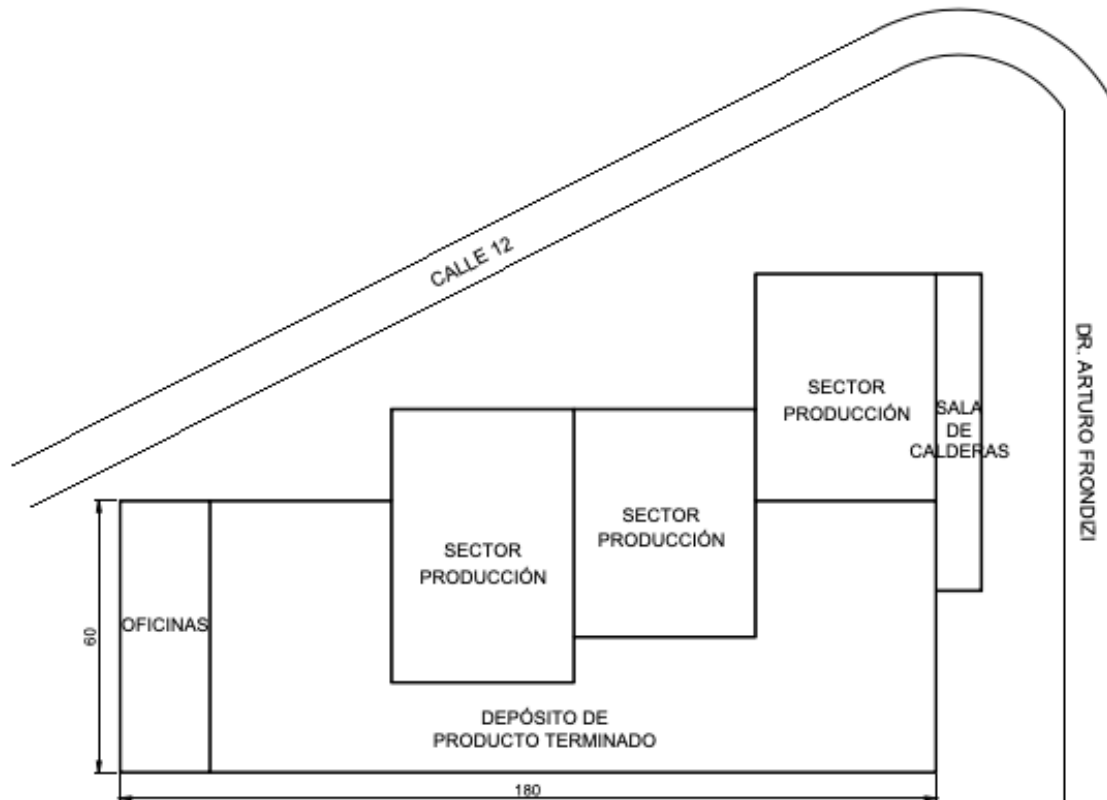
Layout de planta. elaboración propia AutoCAD.
